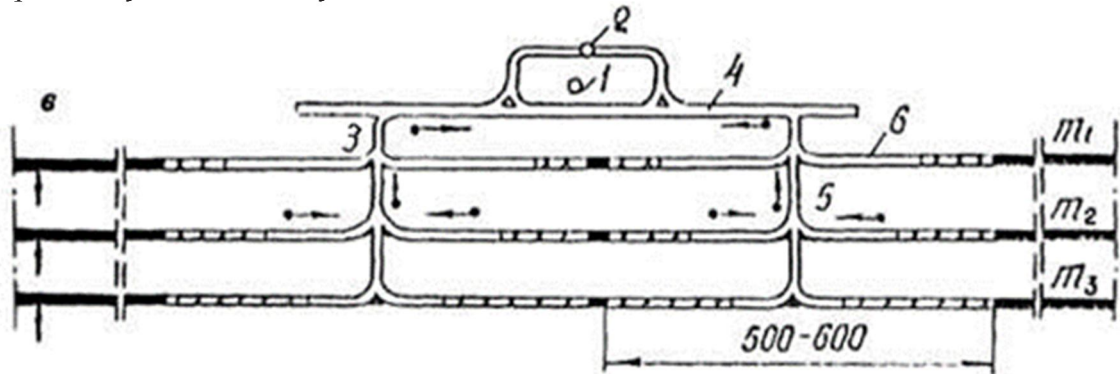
Групповая подготовка с доставкой на двусторонний (в) промквертлаг: 1 — главный ствол; 2 — вспомогательный ствол; 3 — главный квертлаг; 4 — полевой штрек; 5 — промежуточный квертлаг; 6 — пластовой откаточный штрек.
